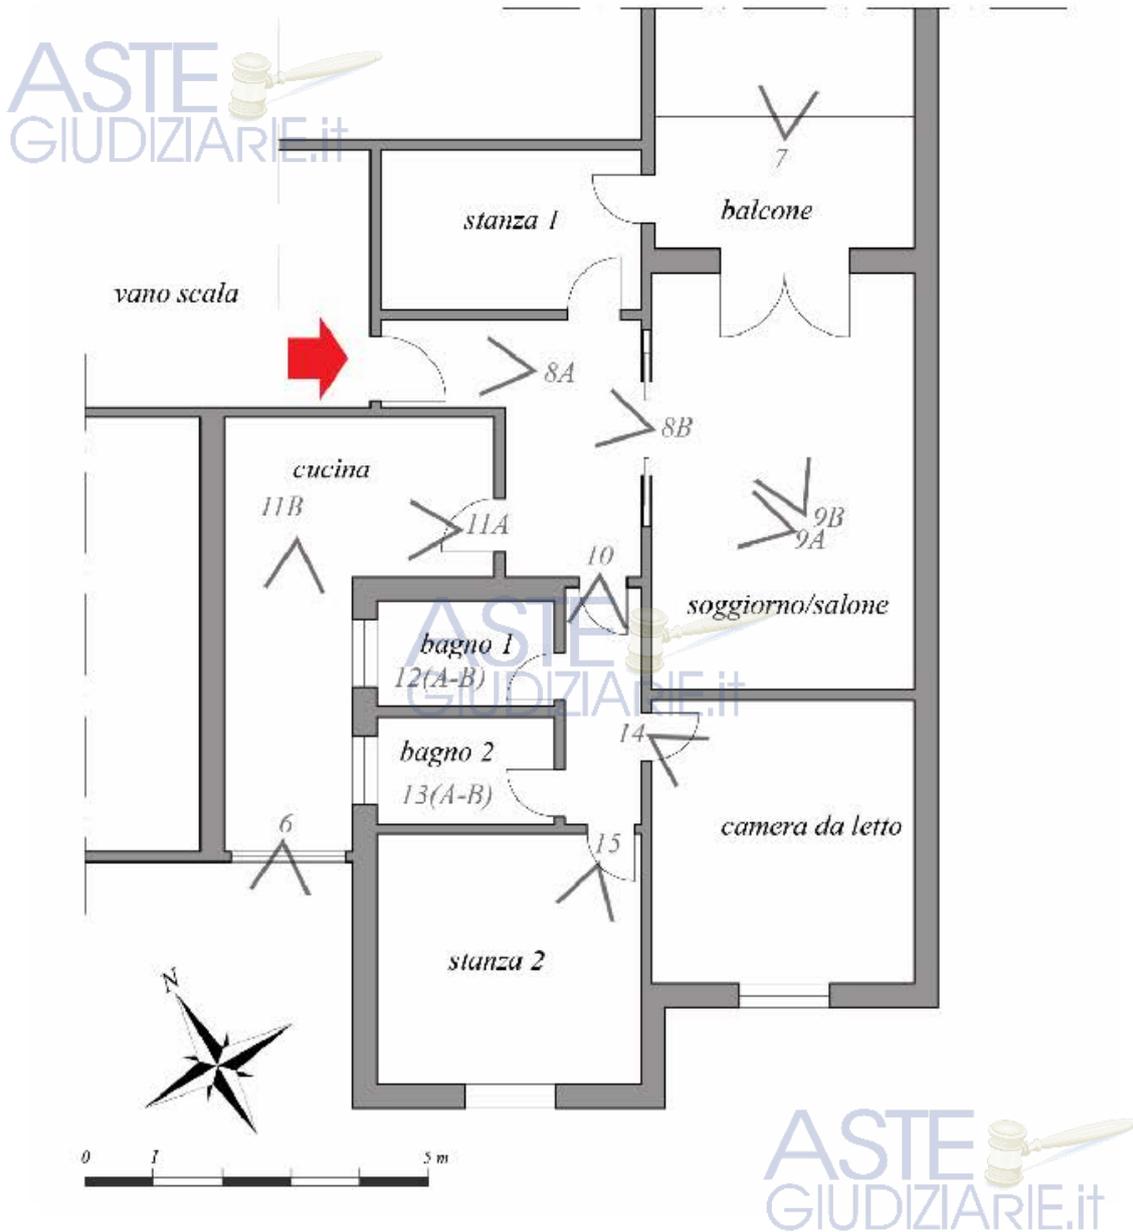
planimetria appartamento stato di fatto con individuazione foto
